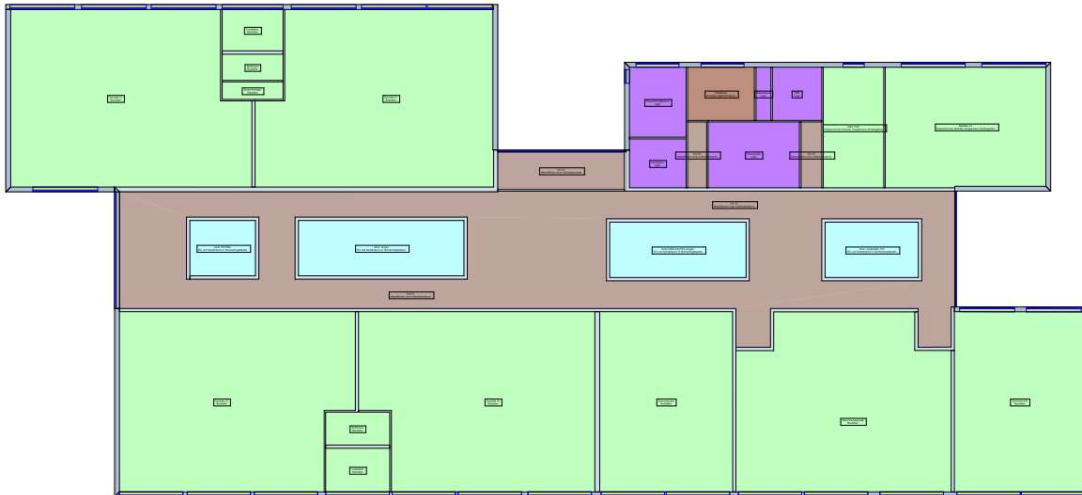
Grundriss Erdgeschoss, zoniert
